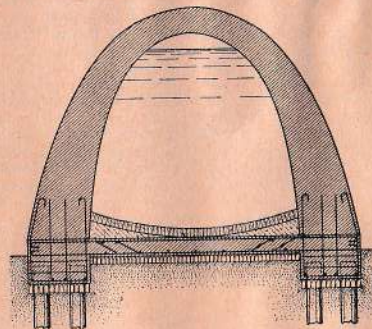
Betondurchlaß mit Pfahlgründung auf moorigem Untergrund.
